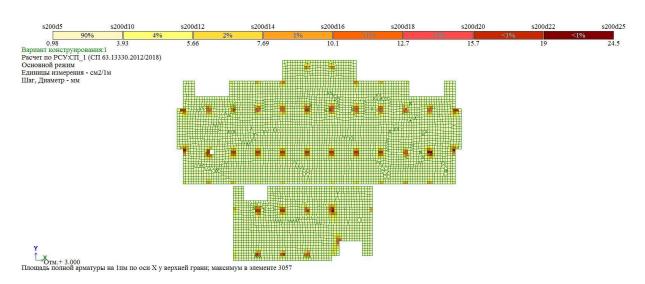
«Верхняя арматура в плите перекрытия вдоль оси X» [35]
